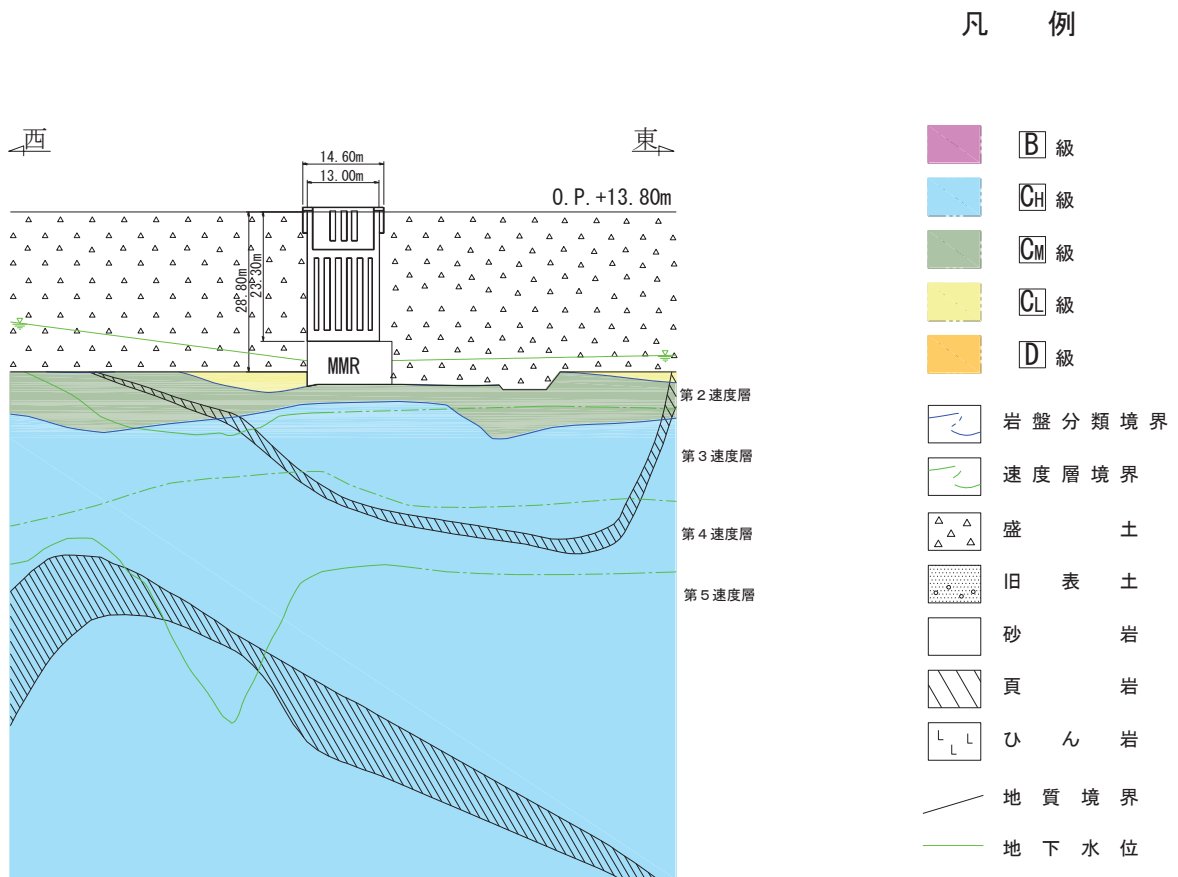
第 3 号機補機冷却海水系放水ピット 地震時荷重算出用地質断面図 (EW 断面)
